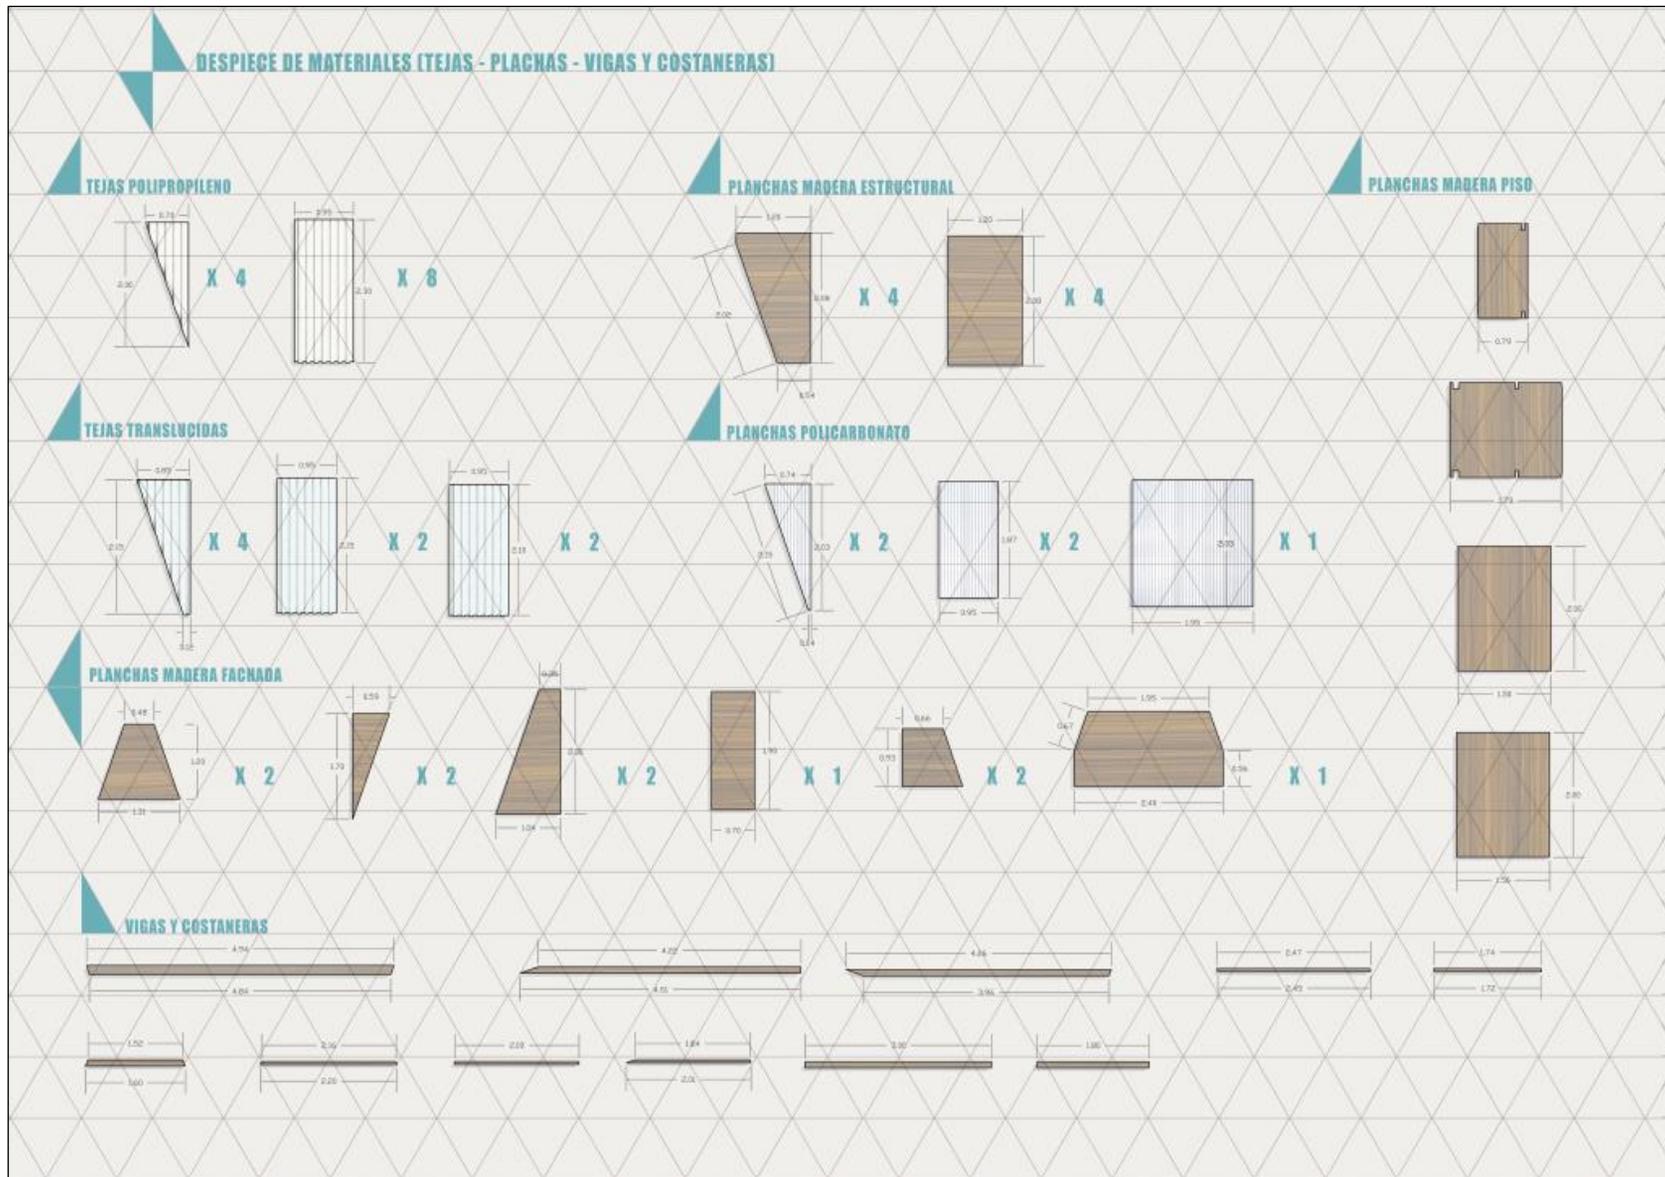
Piezas necesarias para la construcción de la vivienda emergente Casa Techo
